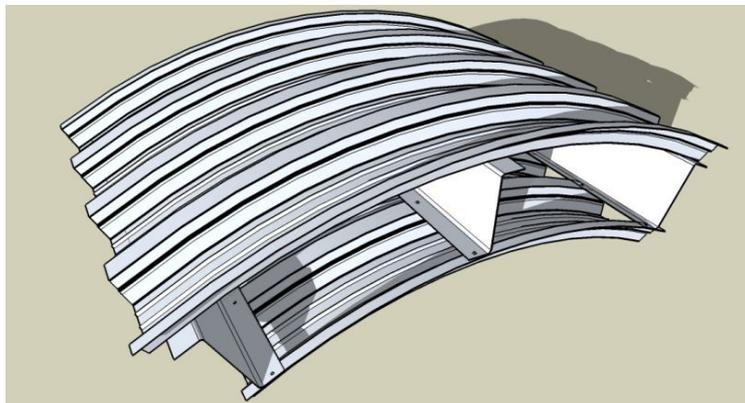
Внешний вид цилиндрической двухслойной панели со связями в виде Z-профилей
